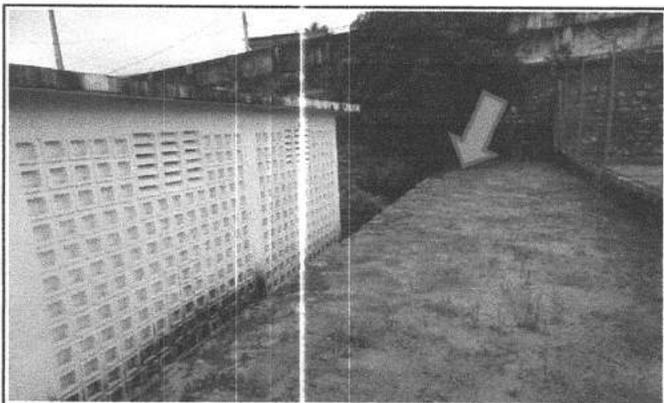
COMPLEMENTAÇÃO DE MURO DE CONTORNO
